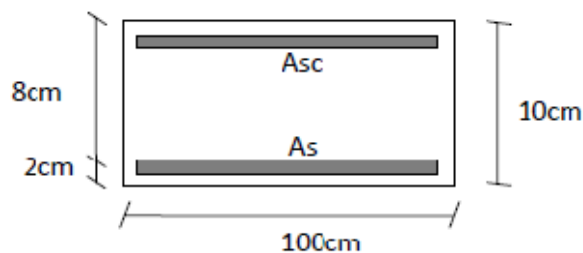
Dimensions de la section pour le calcul du ferrailage
